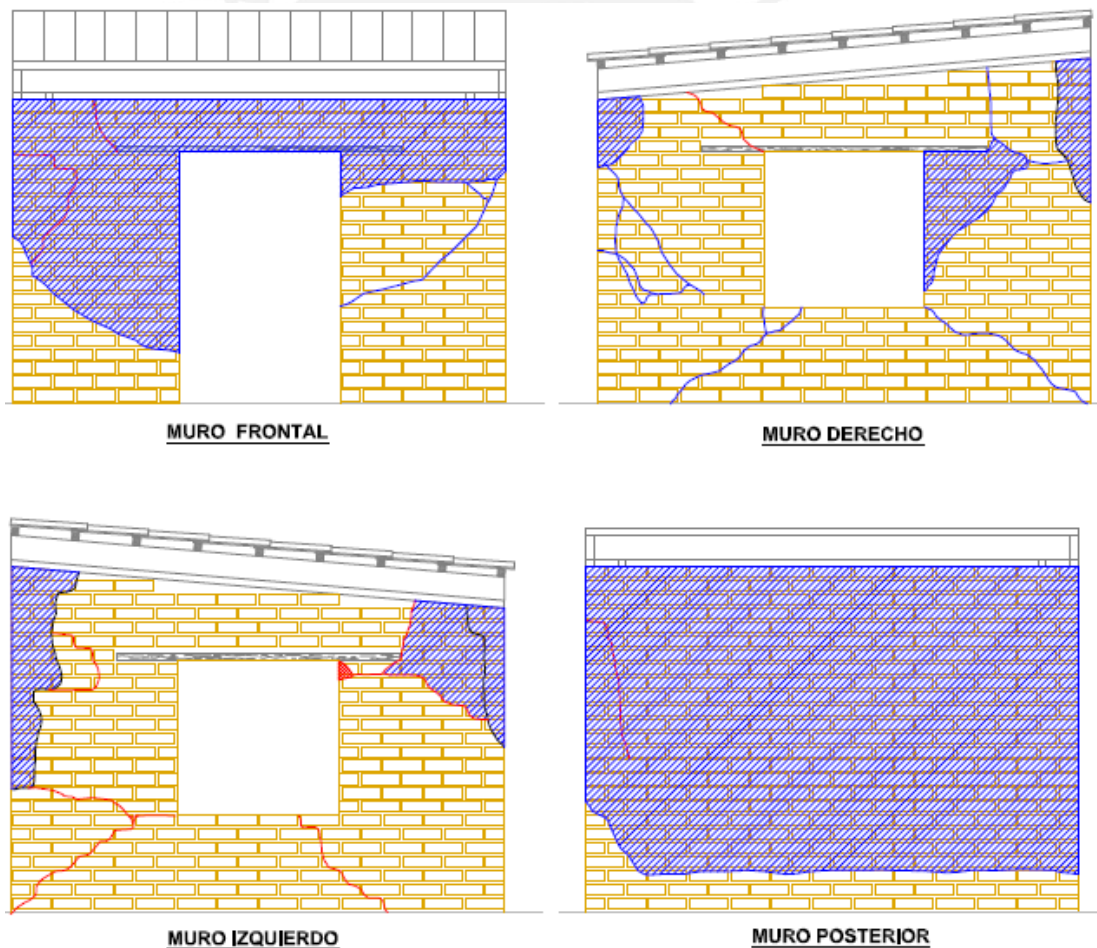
Grietas en muros exteriores del módulo M000
